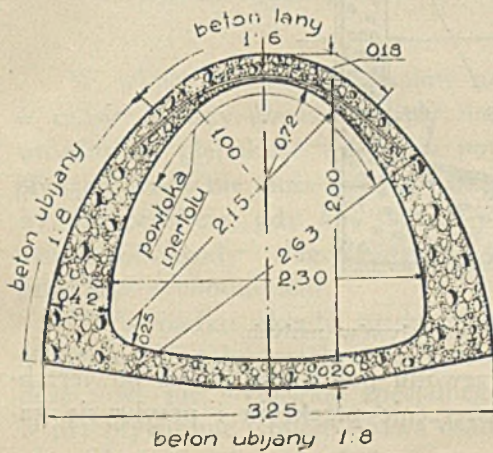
Przekrój półparaboliczny (Portsmouth — St. Zjedn. Am. Płn.).
